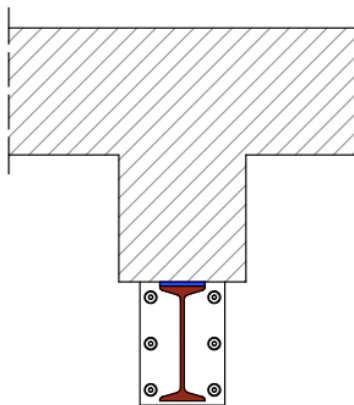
Sección refuerzo de viga mediante perfil IPN. Fuente propia.
